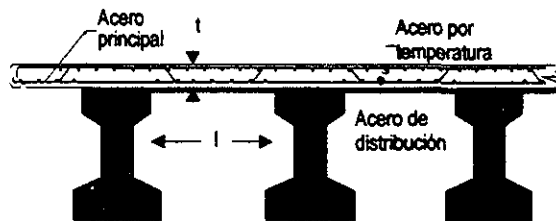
Sección transversal en una losa de concreto mostrando el acero de refuerzo.
